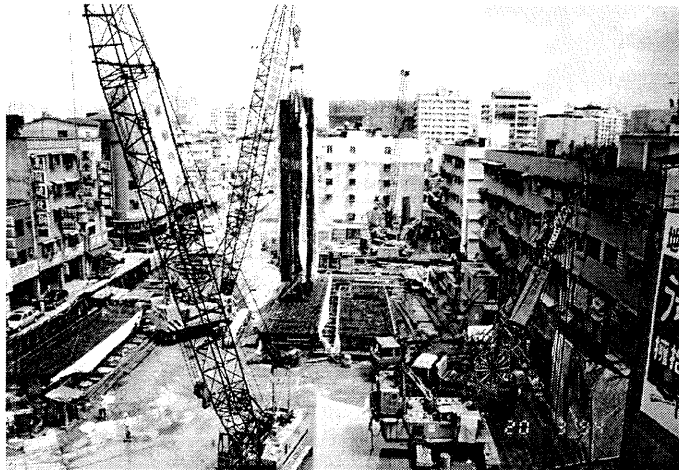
U-Bahn Taipeh - Einbau von Bewehrungskörben in Schlitzwände
